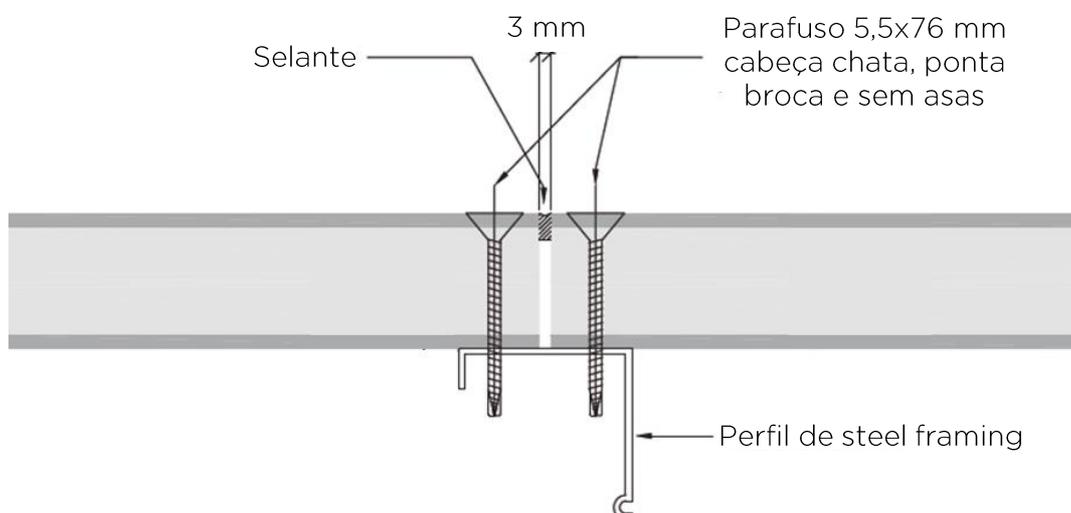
Detalhe de fixação do Painel Ultraboard Brasilit sobre perfil de LSF.
